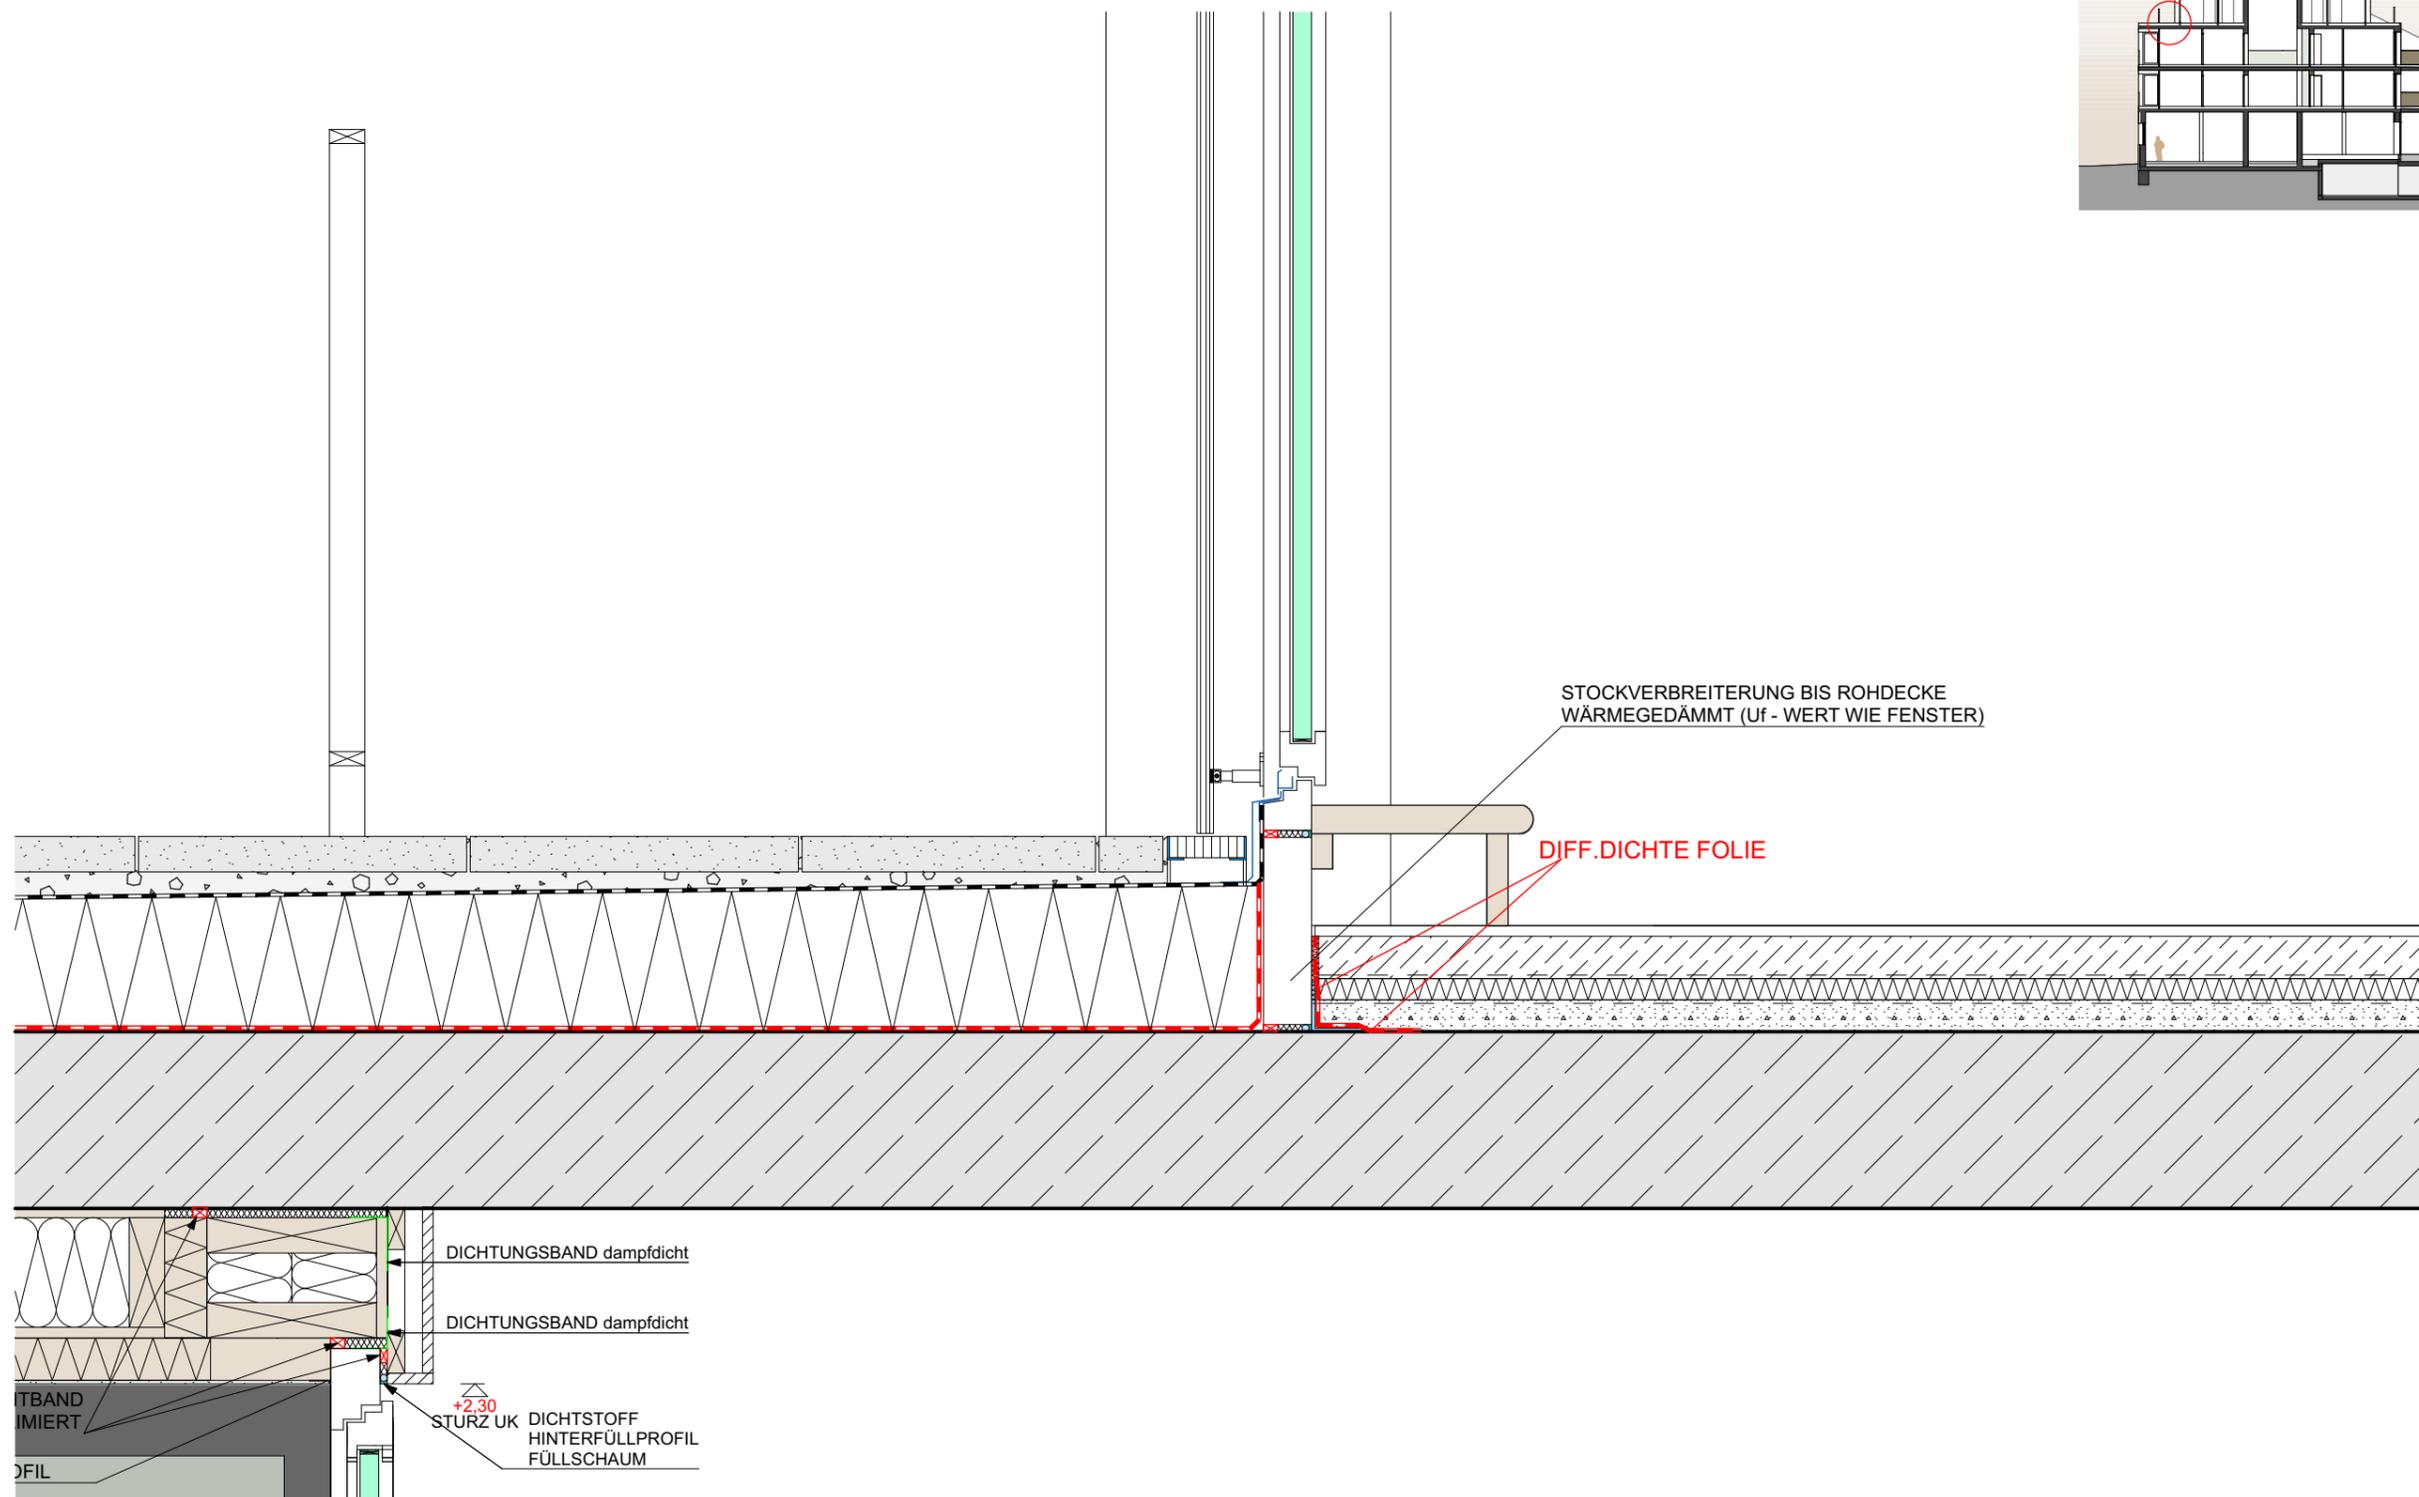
Bauteil 1: Anschluss Dachterrasse 1:10
